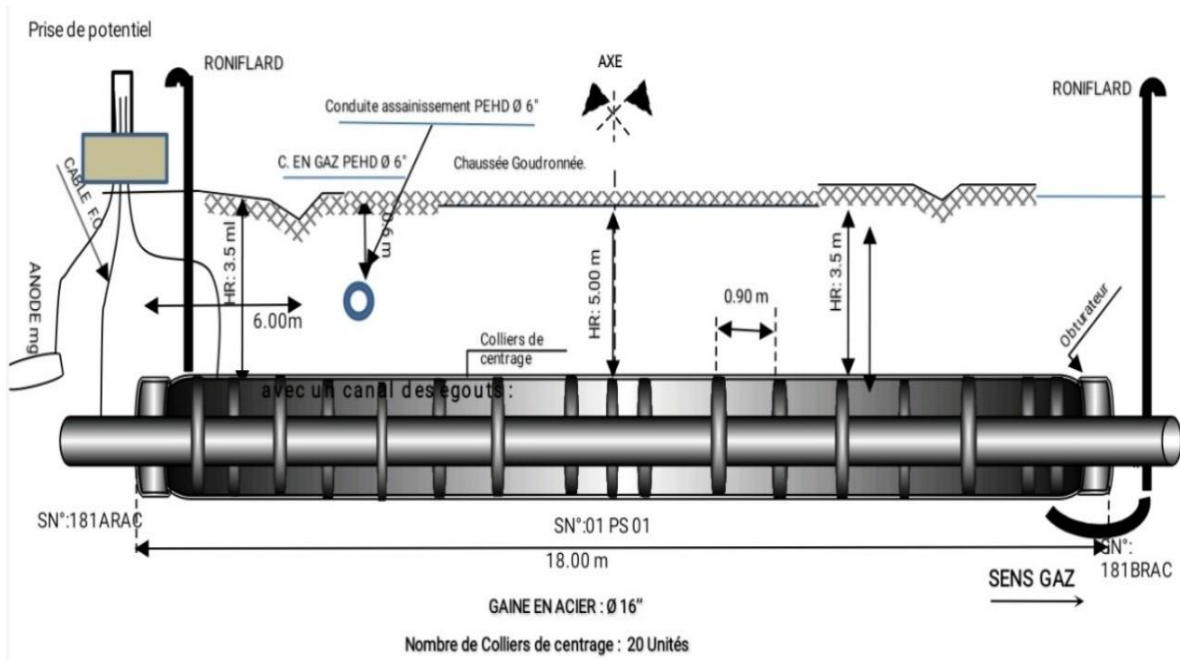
Croquis de traversée de route et croisement de canal d'égout (Pk : 2+009.24).
